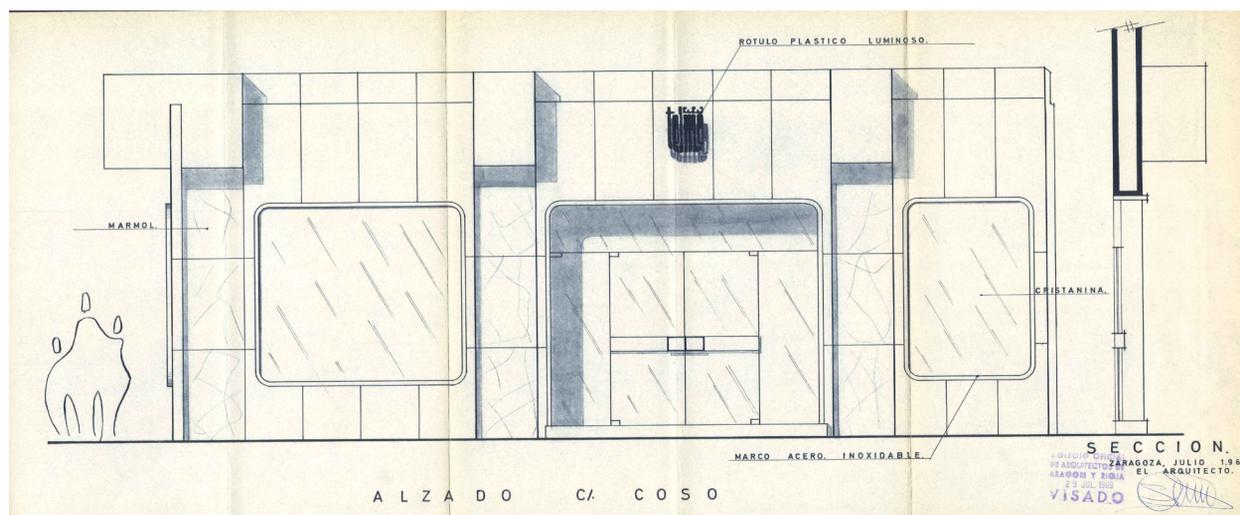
Santiago Castellet Marín, Plano. Sección. Alzado calle Coso. Proyecto de fachada para la *cafetería Italia*, julio de 1969 (Archivo Municipal de Zaragoza)..
